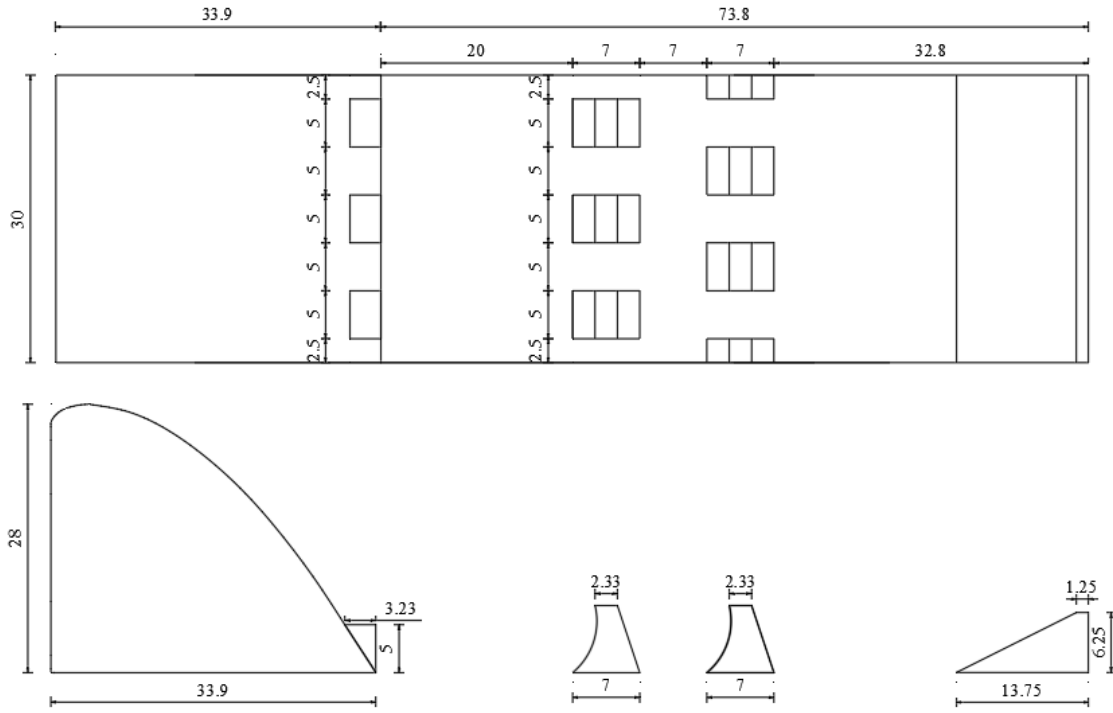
Basamak kesitli tek sıra enerji kırıcı blokların yerleşim planı
